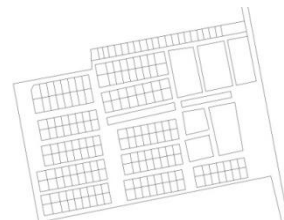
Site Plan Cipta Griya Persada Sumber : Siteplan Perumahan dan Survey Lapangan, 2014
